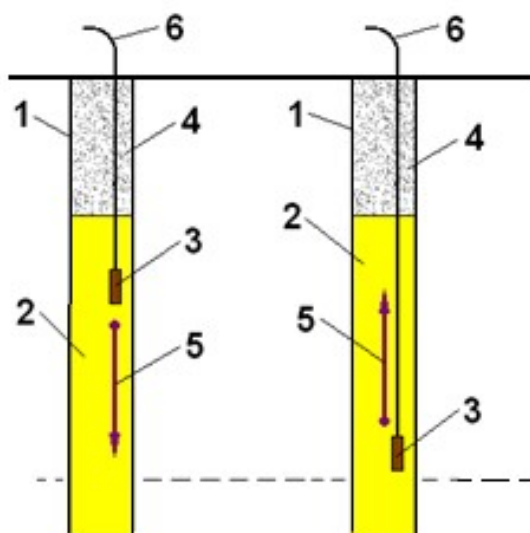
Конструкції свердловинних зарядів при різних напрямках ініціювання: а) зверху; б) знизу; 1 – свердловина; 2 – заряд ВР; 3 – проміжний детонатор; 4 – набивка; 5 – напрямок ініціювання; 6 – ДШ
